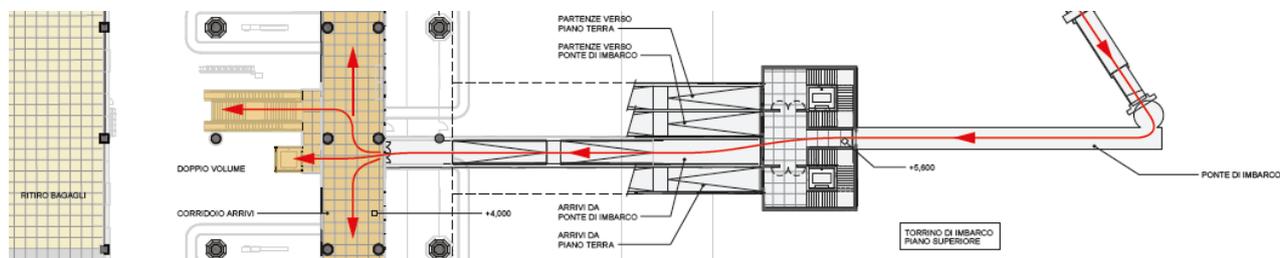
| Schema planimetrico di funzionamento flussi di sbarco da finger a mezzanino
